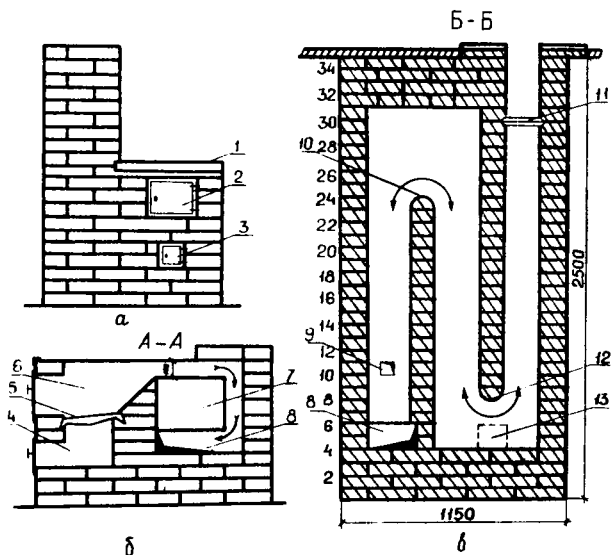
Отопительно-варочная печь № 6: а — вид спереди; б — разрез по линии А—А; в — разрез по линии Б—Б; 1 — обрамление плиты уголком; 2 — топочная дверка; 3 — поддувальная дверка; 4 — зольник; 5 — колосники; 6 — топливник; 7 — духовка; 8 — канал под духовку; 9 — подсосный канал; 10 — перевал; 11 — задвижка; 12 — подверток; 13 — окно чистки
